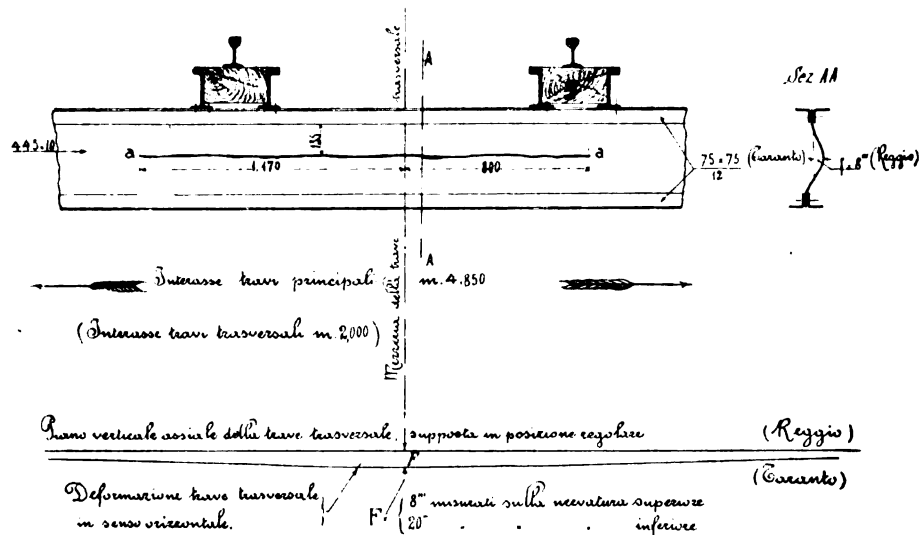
Travata continua in tre campate di lunghezza totale 84,28 m., a passaggio inferiore, aperta sopra, con travi maestre a reticolati di barre piatte (tipo calabro-siculo). — *a a*, sezione completamente visibile sulla faccia verso Reggio (parte convessa), ma visibile nella mezzera anche sulla faccia Tarento (parte concava). — La parte si è deformata come in *f*, mentre ha subito altra deformazione in senso orizzontale con freccia massima *F*. Notasi che quest'ultima deformazione od incurvamento in senso orizzontale si riscontra in molte travi trasversali di travate analoghe, aventi le lungherine sovrapposte alle travi trasversali; per lo più l'incurvamento è limitato alle nervature inferiori delle travi.
